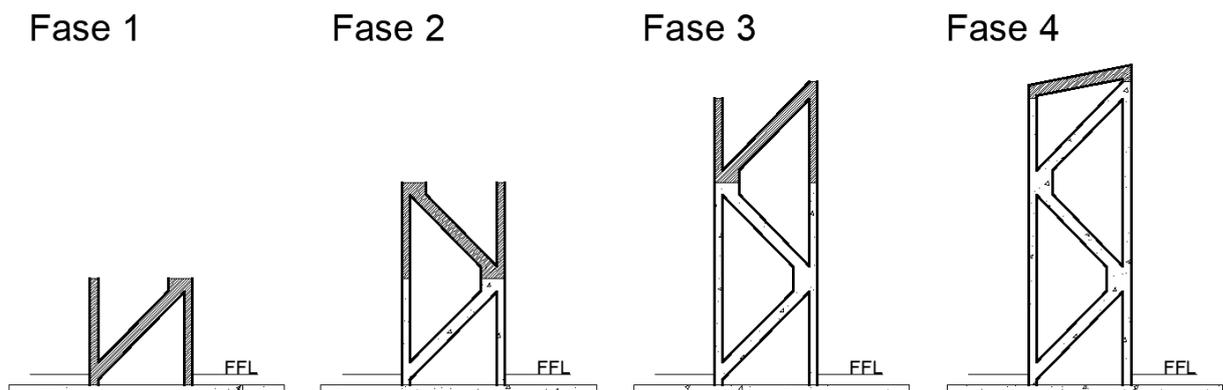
Fases das betonagens de contraventamentos em betão armado
